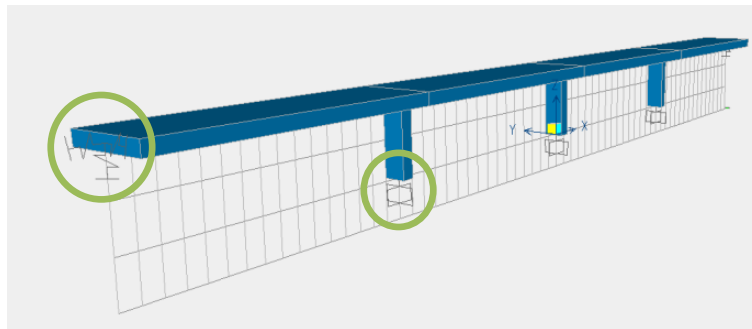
Pilas empotradas y estribos modelados con resortes.
